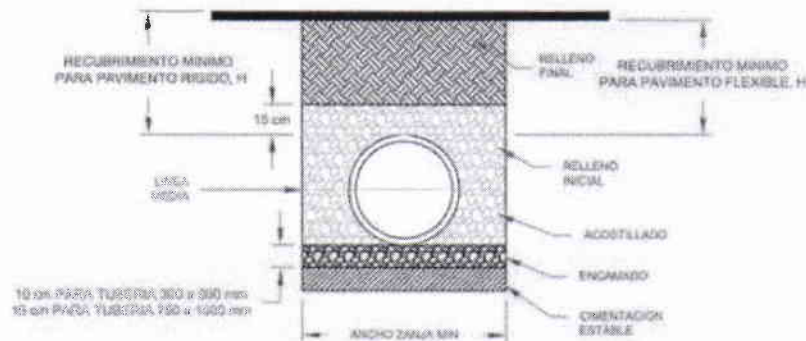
Zanja y rellenos típicos para una tubería ADS.
